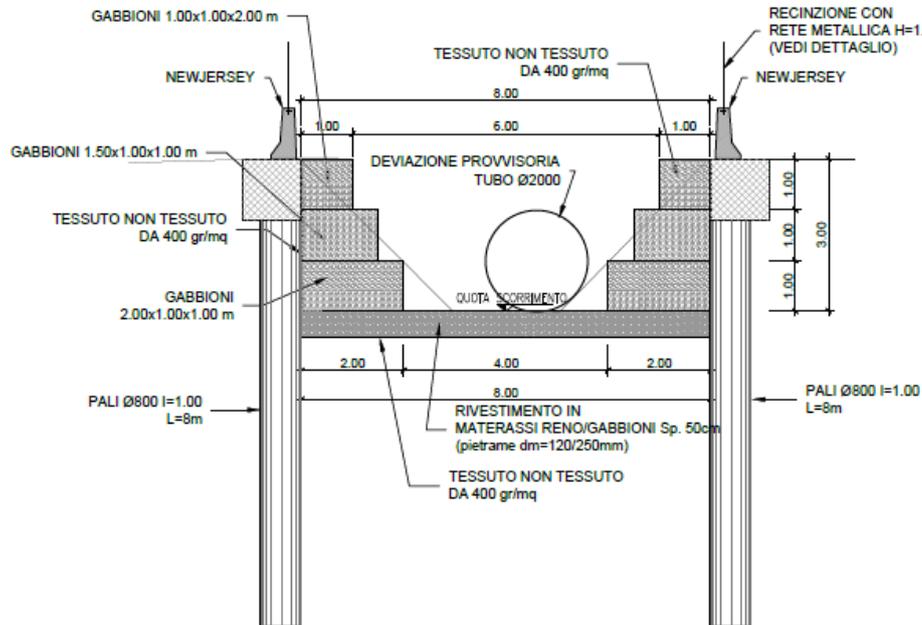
Opere idrauliche nella stazione di Ellera: sezione trasversale
